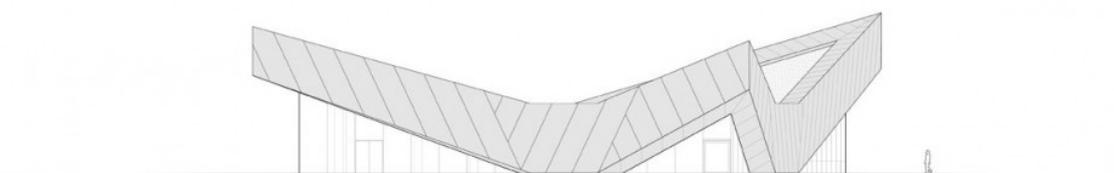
ELEVAÇÃO SUDOESTE – GALERIA TRIPLE V
